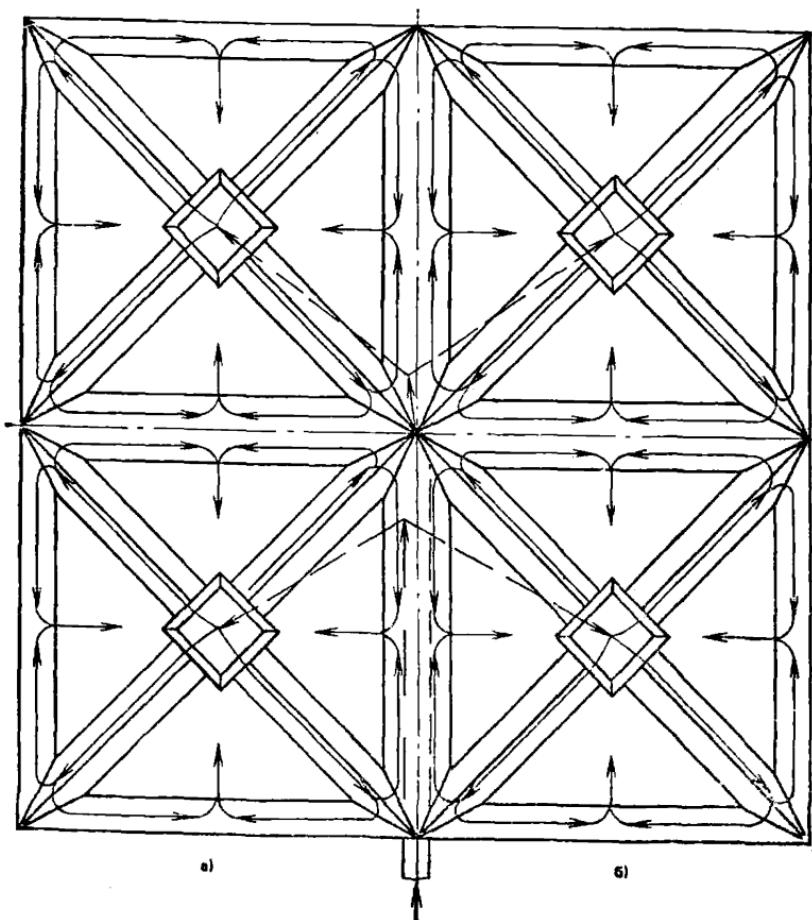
Схема бетонирования монтажного блока структурного покрытия
